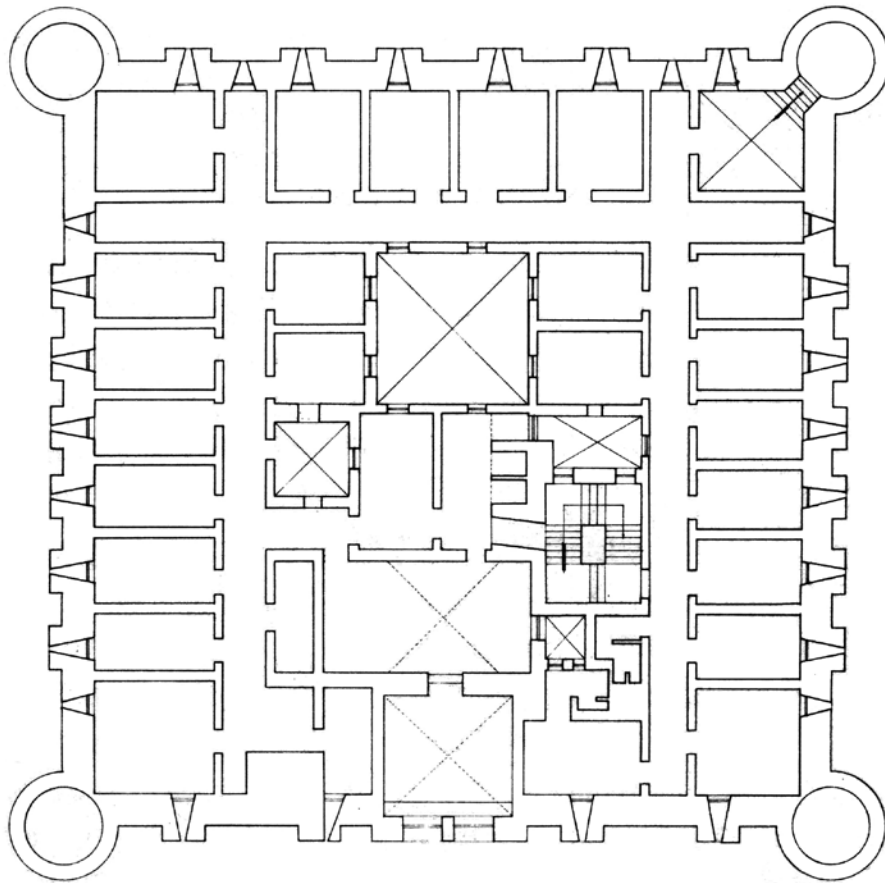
„A horizontal plan of the second floor“ (SAFWAT EL ALFY 1984).
